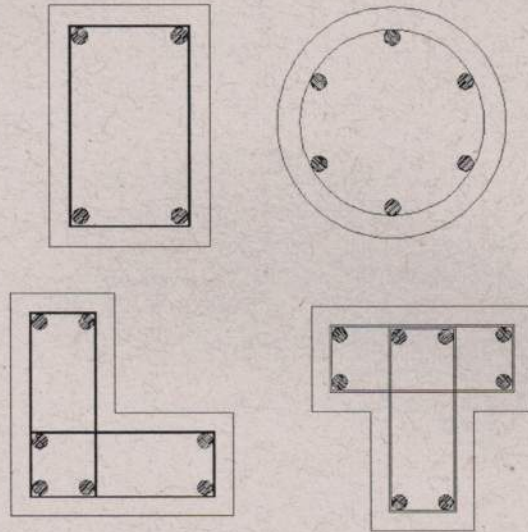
Número mínimo de barras (Pinheiro 2009)
